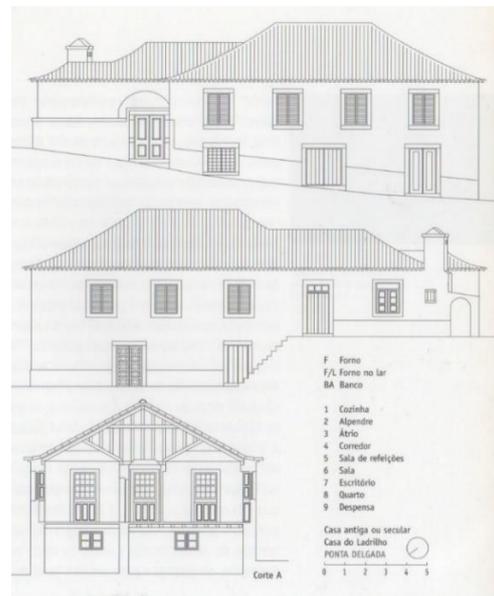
Fachadas e corte da Casa do Ladrilho.
